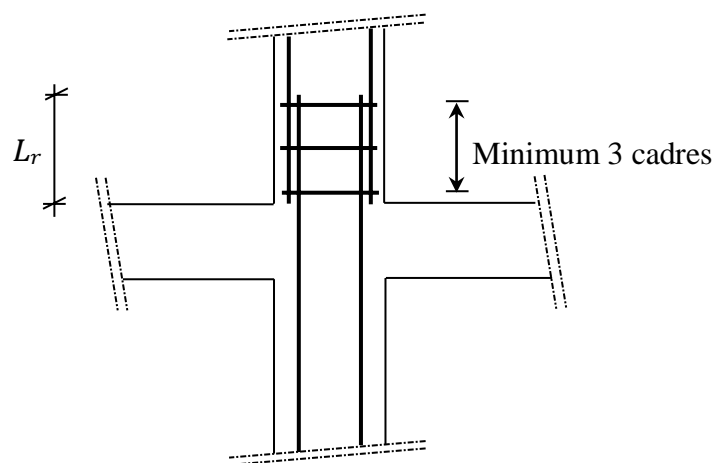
Les armatures transversales dans la zone de recouvrement
